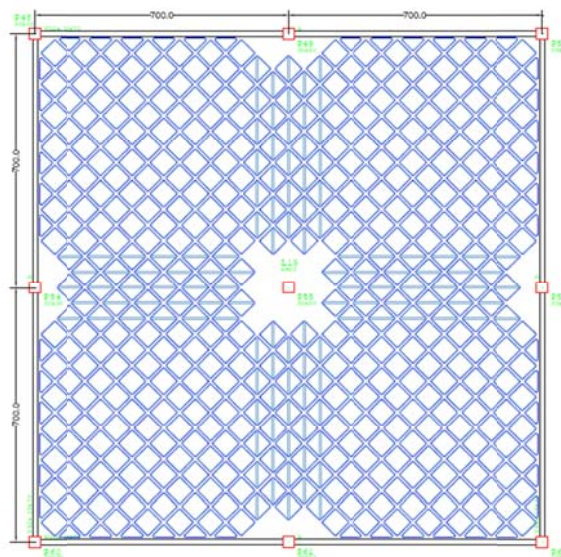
Laje nervurada tridirecional, Sistema Construtivo Tridirecional para Construção de Lajes Nervuradas [3].
